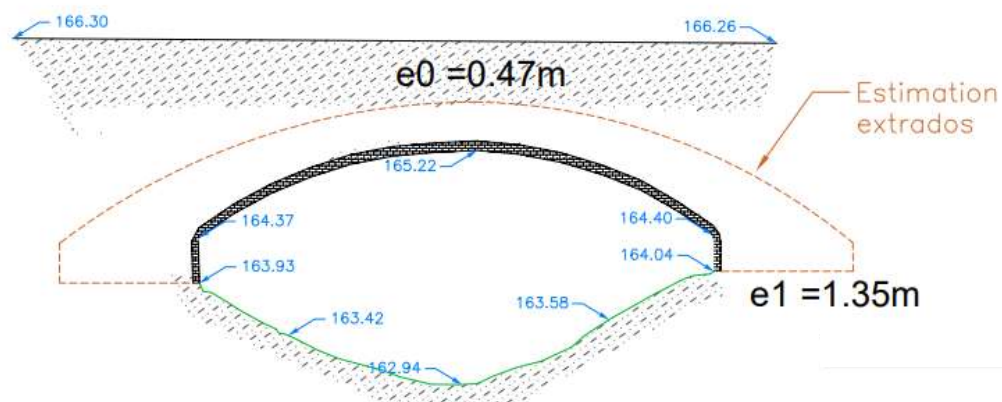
Coupe de l'ouvrage en maçonnerie existant extrait de [12]
